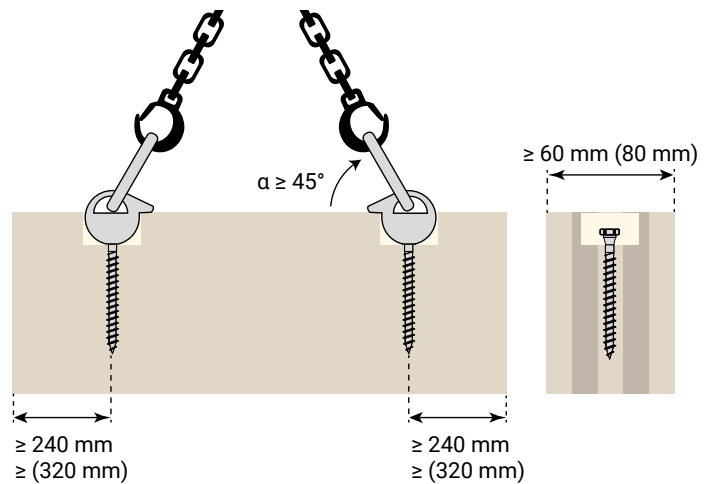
ausschließlich axiale Beanspruchung der Schraube durch passgenaue Topfbohrung bei einem Gehängewinkel von  $\alpha \geq 45^\circ$ . Die Längenangabe gilt jeweils für  $d = 12 \text{ mm}$  ( $d = 16 \text{ mm}$ )
